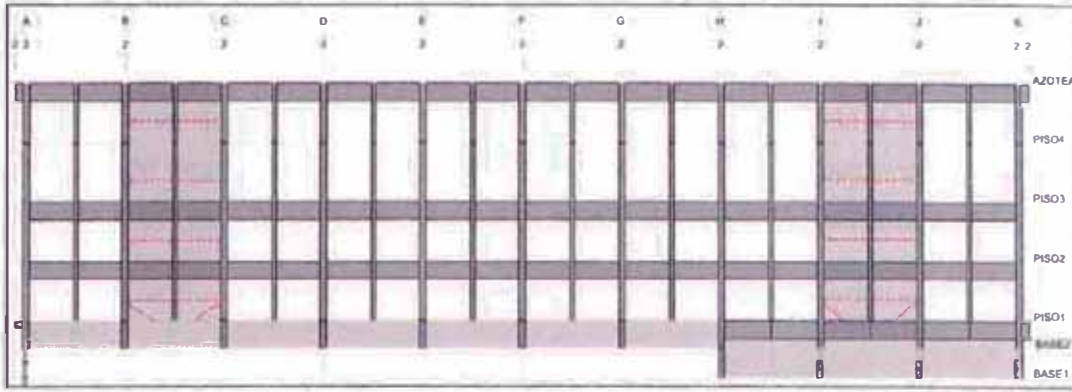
Grietas visibles en el primer piso y fisuras horizontales (líneas discontinuas) en muros estructurales, en los demás niveles superiores.
